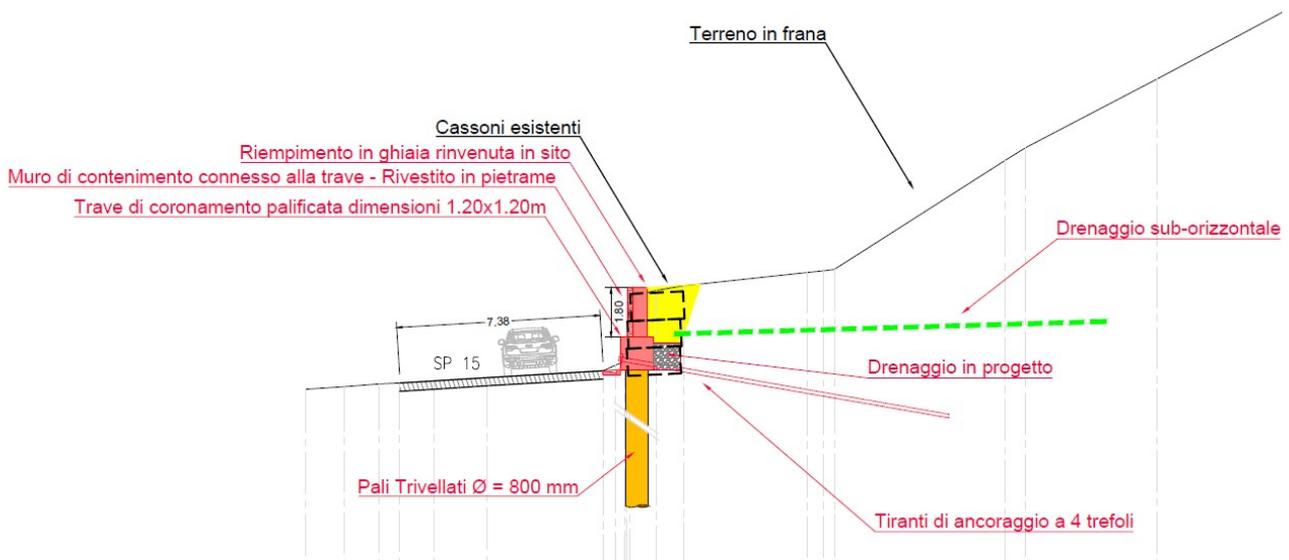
Sezione tipo dell'intervento previsto per il rifacimento dell'opera di sostegno.
